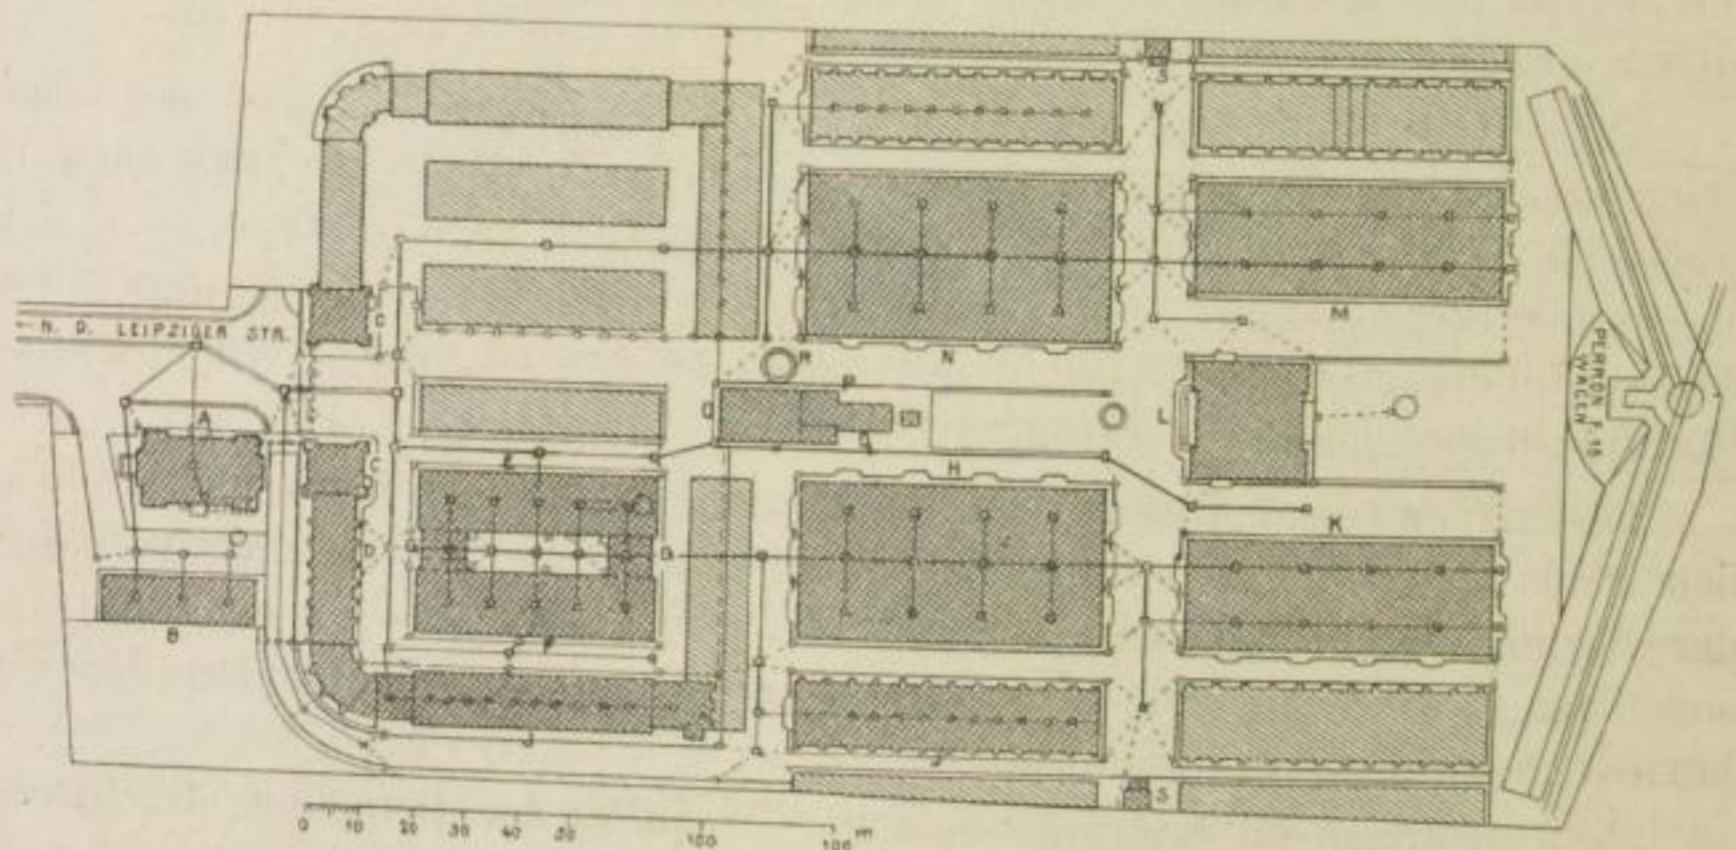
Grundriss des Dresdener Schlachthofes.
